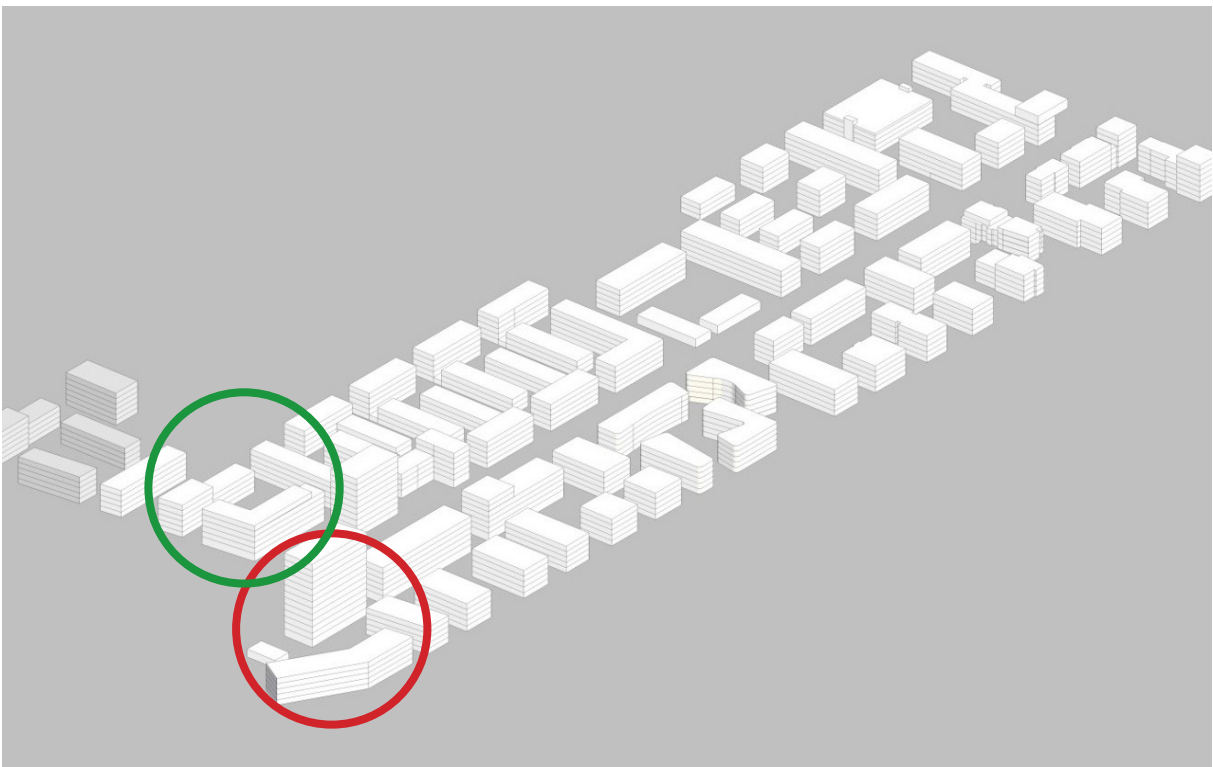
Westlicher Abschluss der Hafenkante (Städtebauliches Modell), Rot Baufeld 7, Grün Baufeld 11
